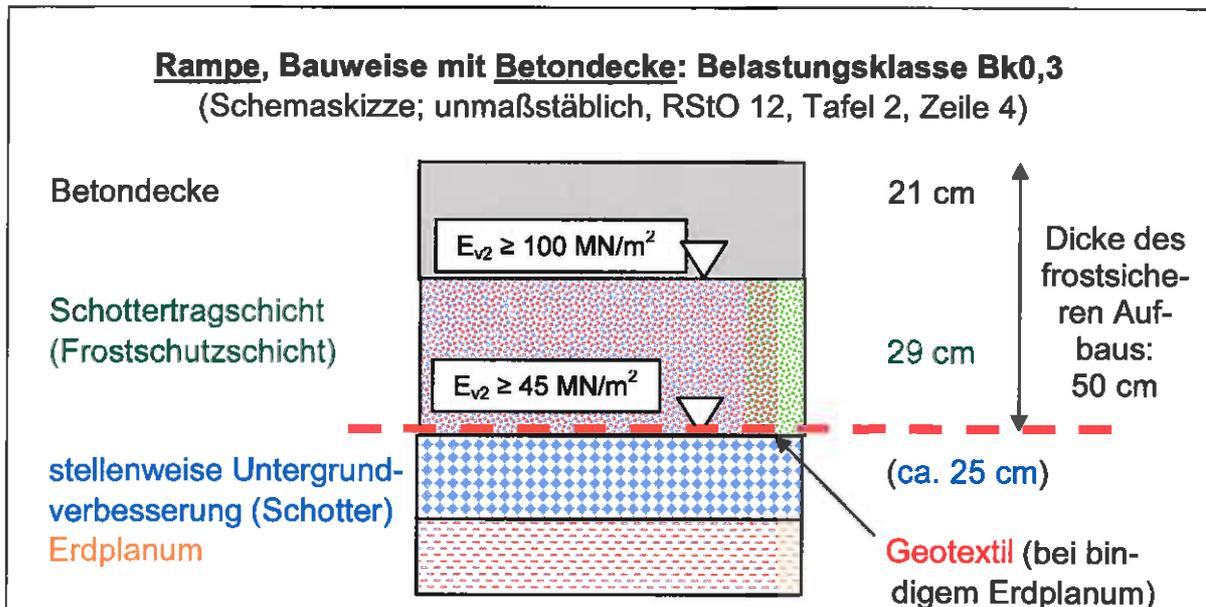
‚Aufbau‘ Betondecke Rampe
